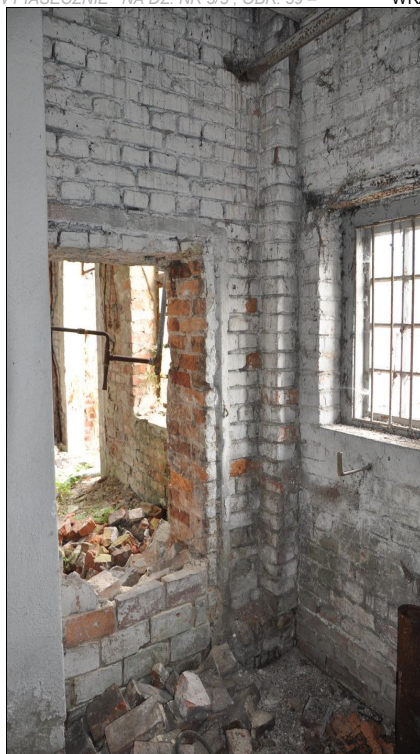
Widok wnętrza kuźni (pozostałość po piecu).
